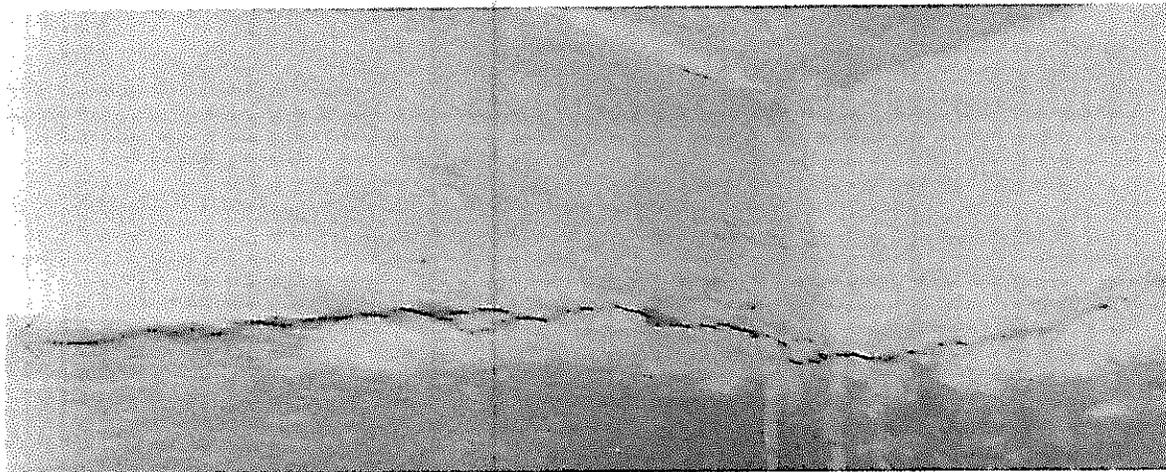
Grieta longitudinal conjunta entre dos muros formando escuadra. "fuente propia".
